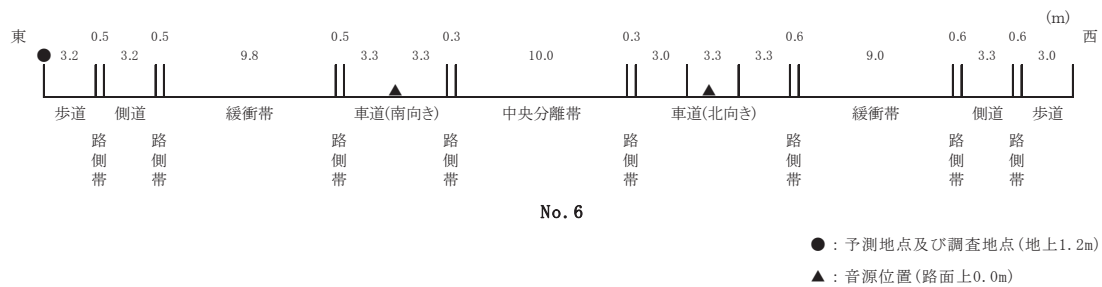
(2) 音源配置図 (道路断面方向の配置イメージ: No. 6の例)
